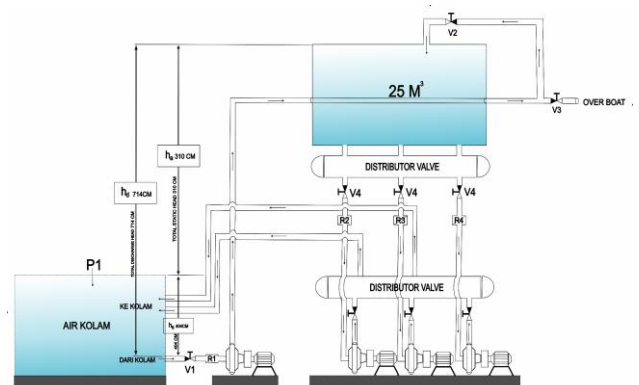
Instalasi Pipa Kolam Latih Water Pit
